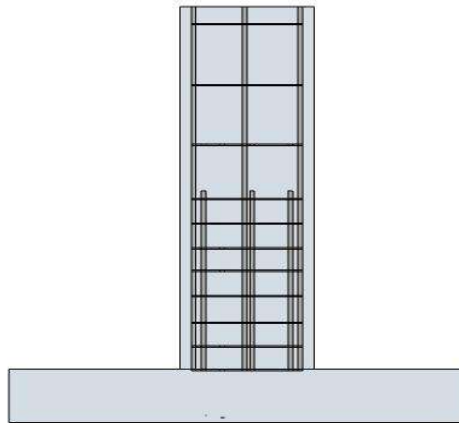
Penulangan pertemuan sudut balok kolom struktur
